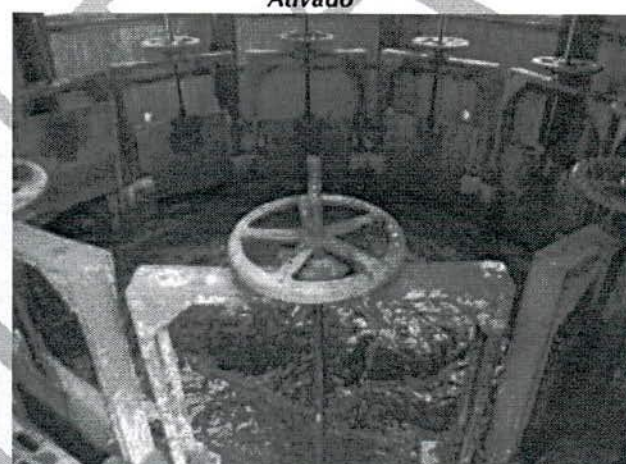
ETE Ipanema – EEE02 – Caixa de Distribuição de Vazão
